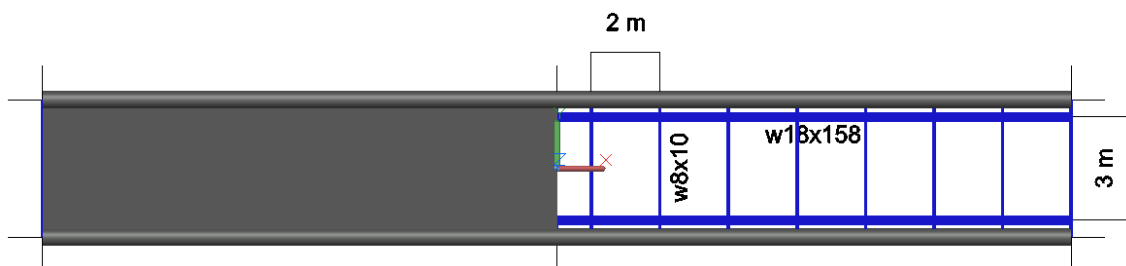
Corte realizado a lo largo de los ejes horizontales de los elementos del grupo de simetría 5. En él se puede apreciar cómo están distribuidas las vigas y que distancias existen entre ellas.
